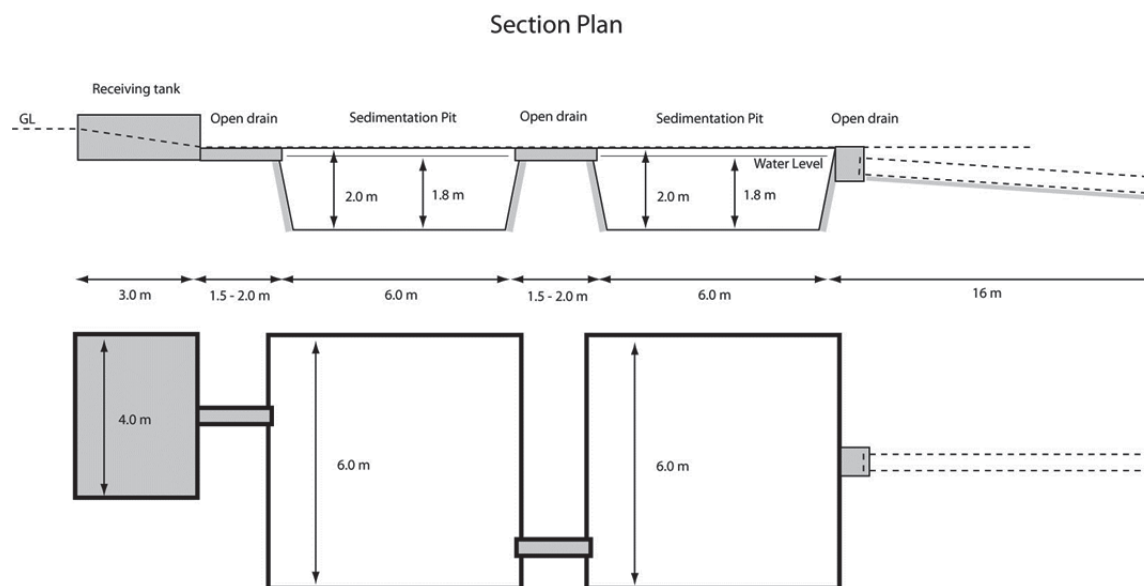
し尿浄化槽汚泥処理施設の竣工平面断面図
